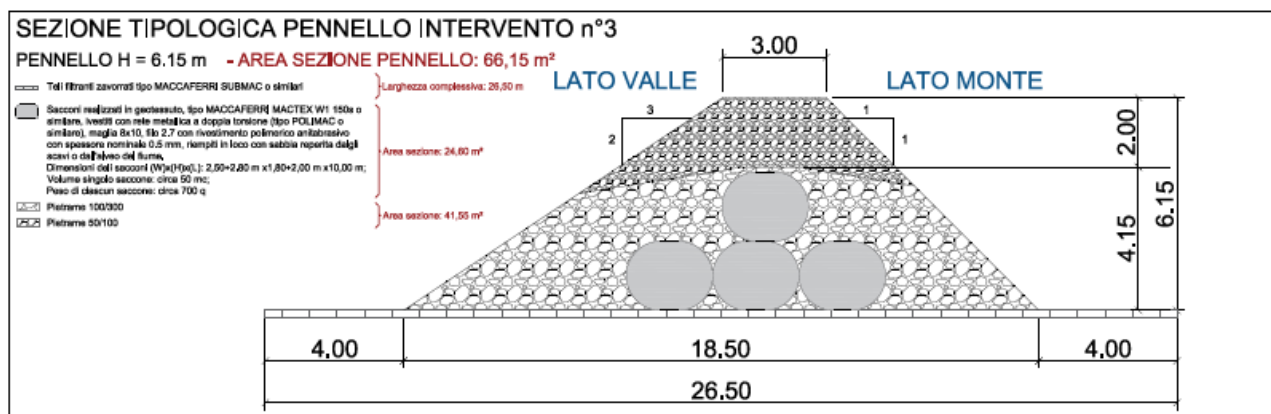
Sezione tipologica esemplificativa delle opere in progetto
